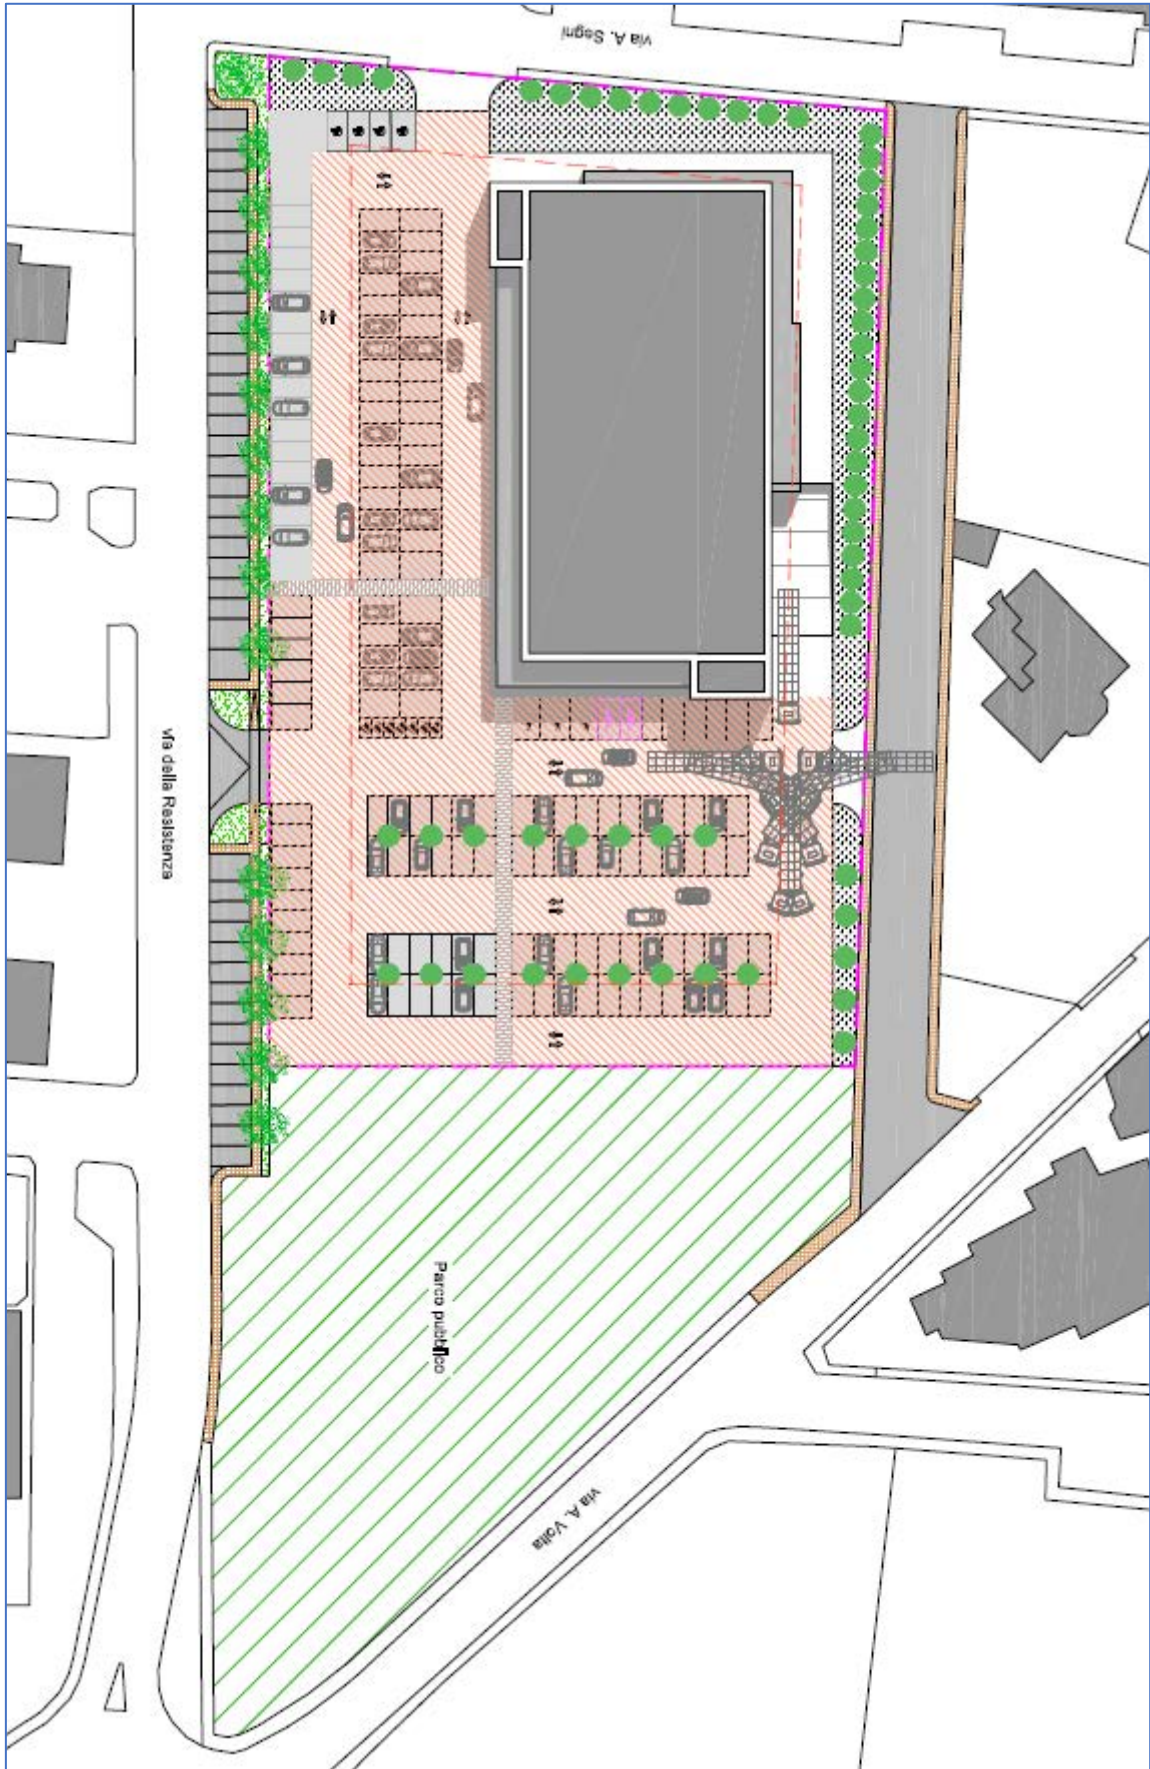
Rappresentazione planimetrica del PUE (Tav. 6).
